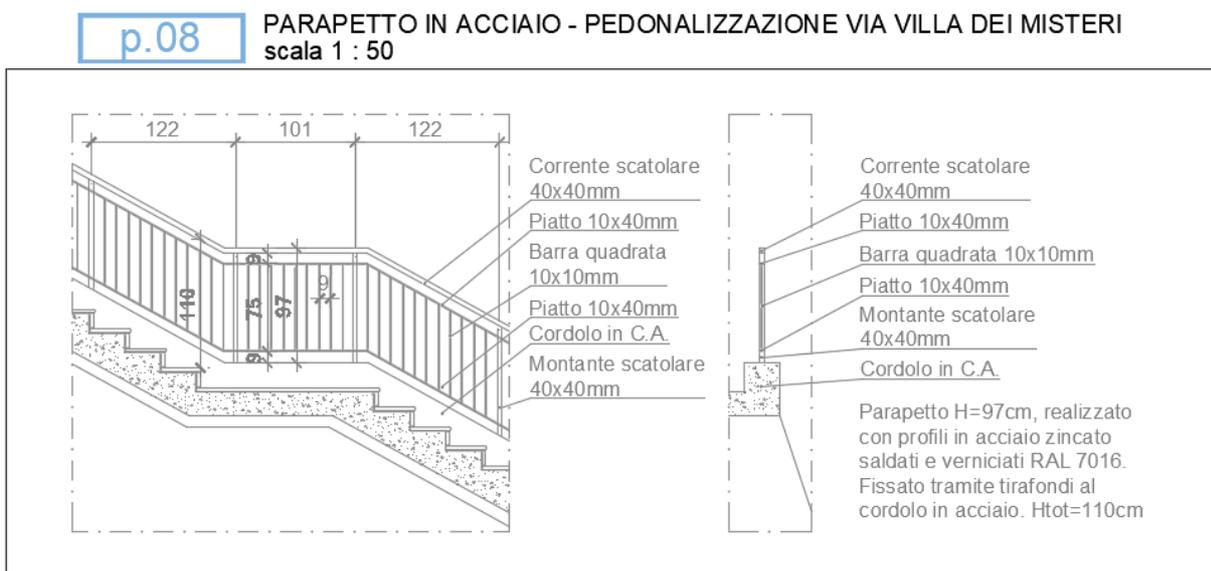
Parapetto scala in terra armata su Via Stabbiana
